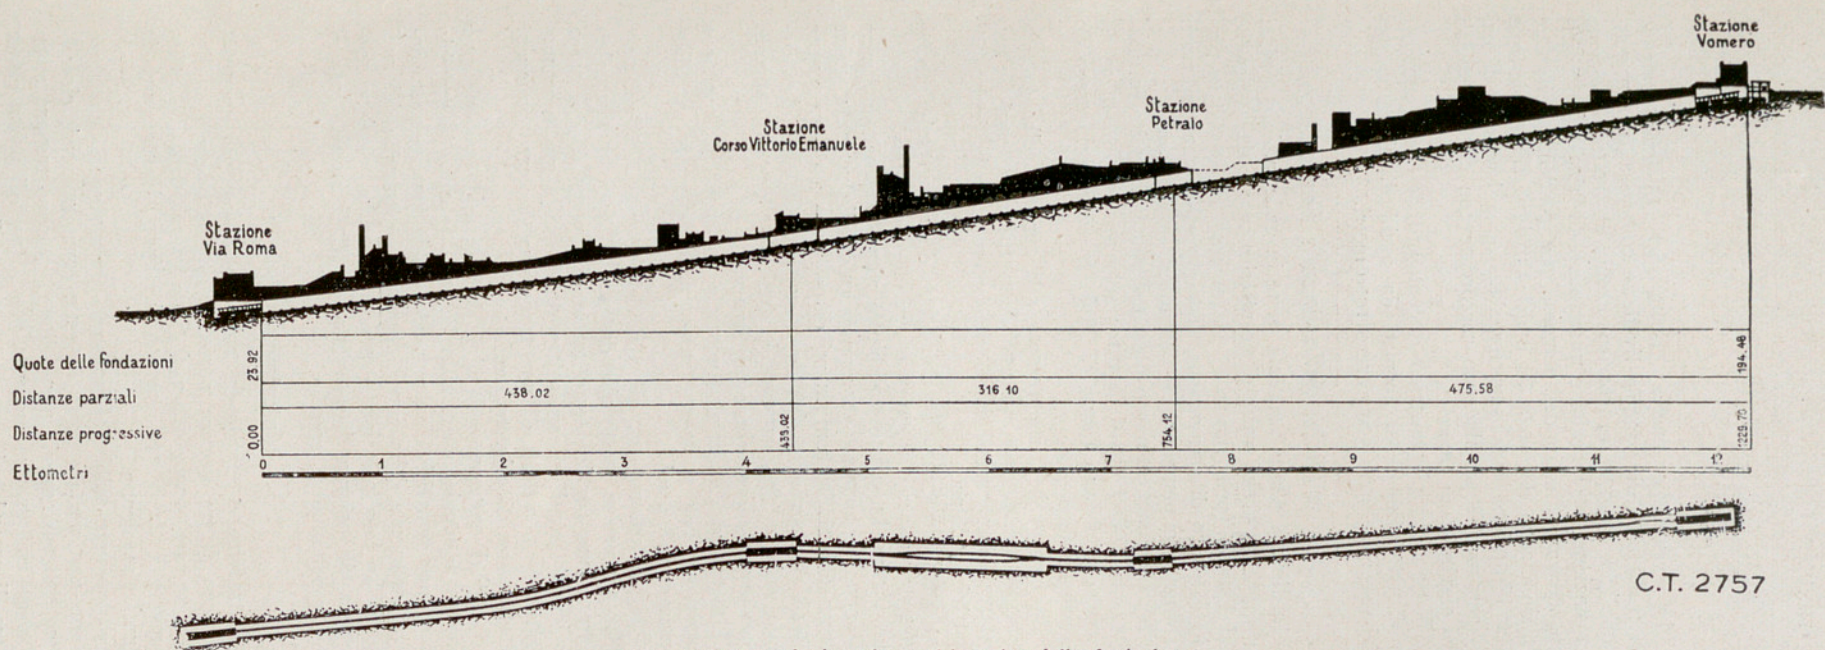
Tracciato planimetrico e altimetrico della funicolare.
